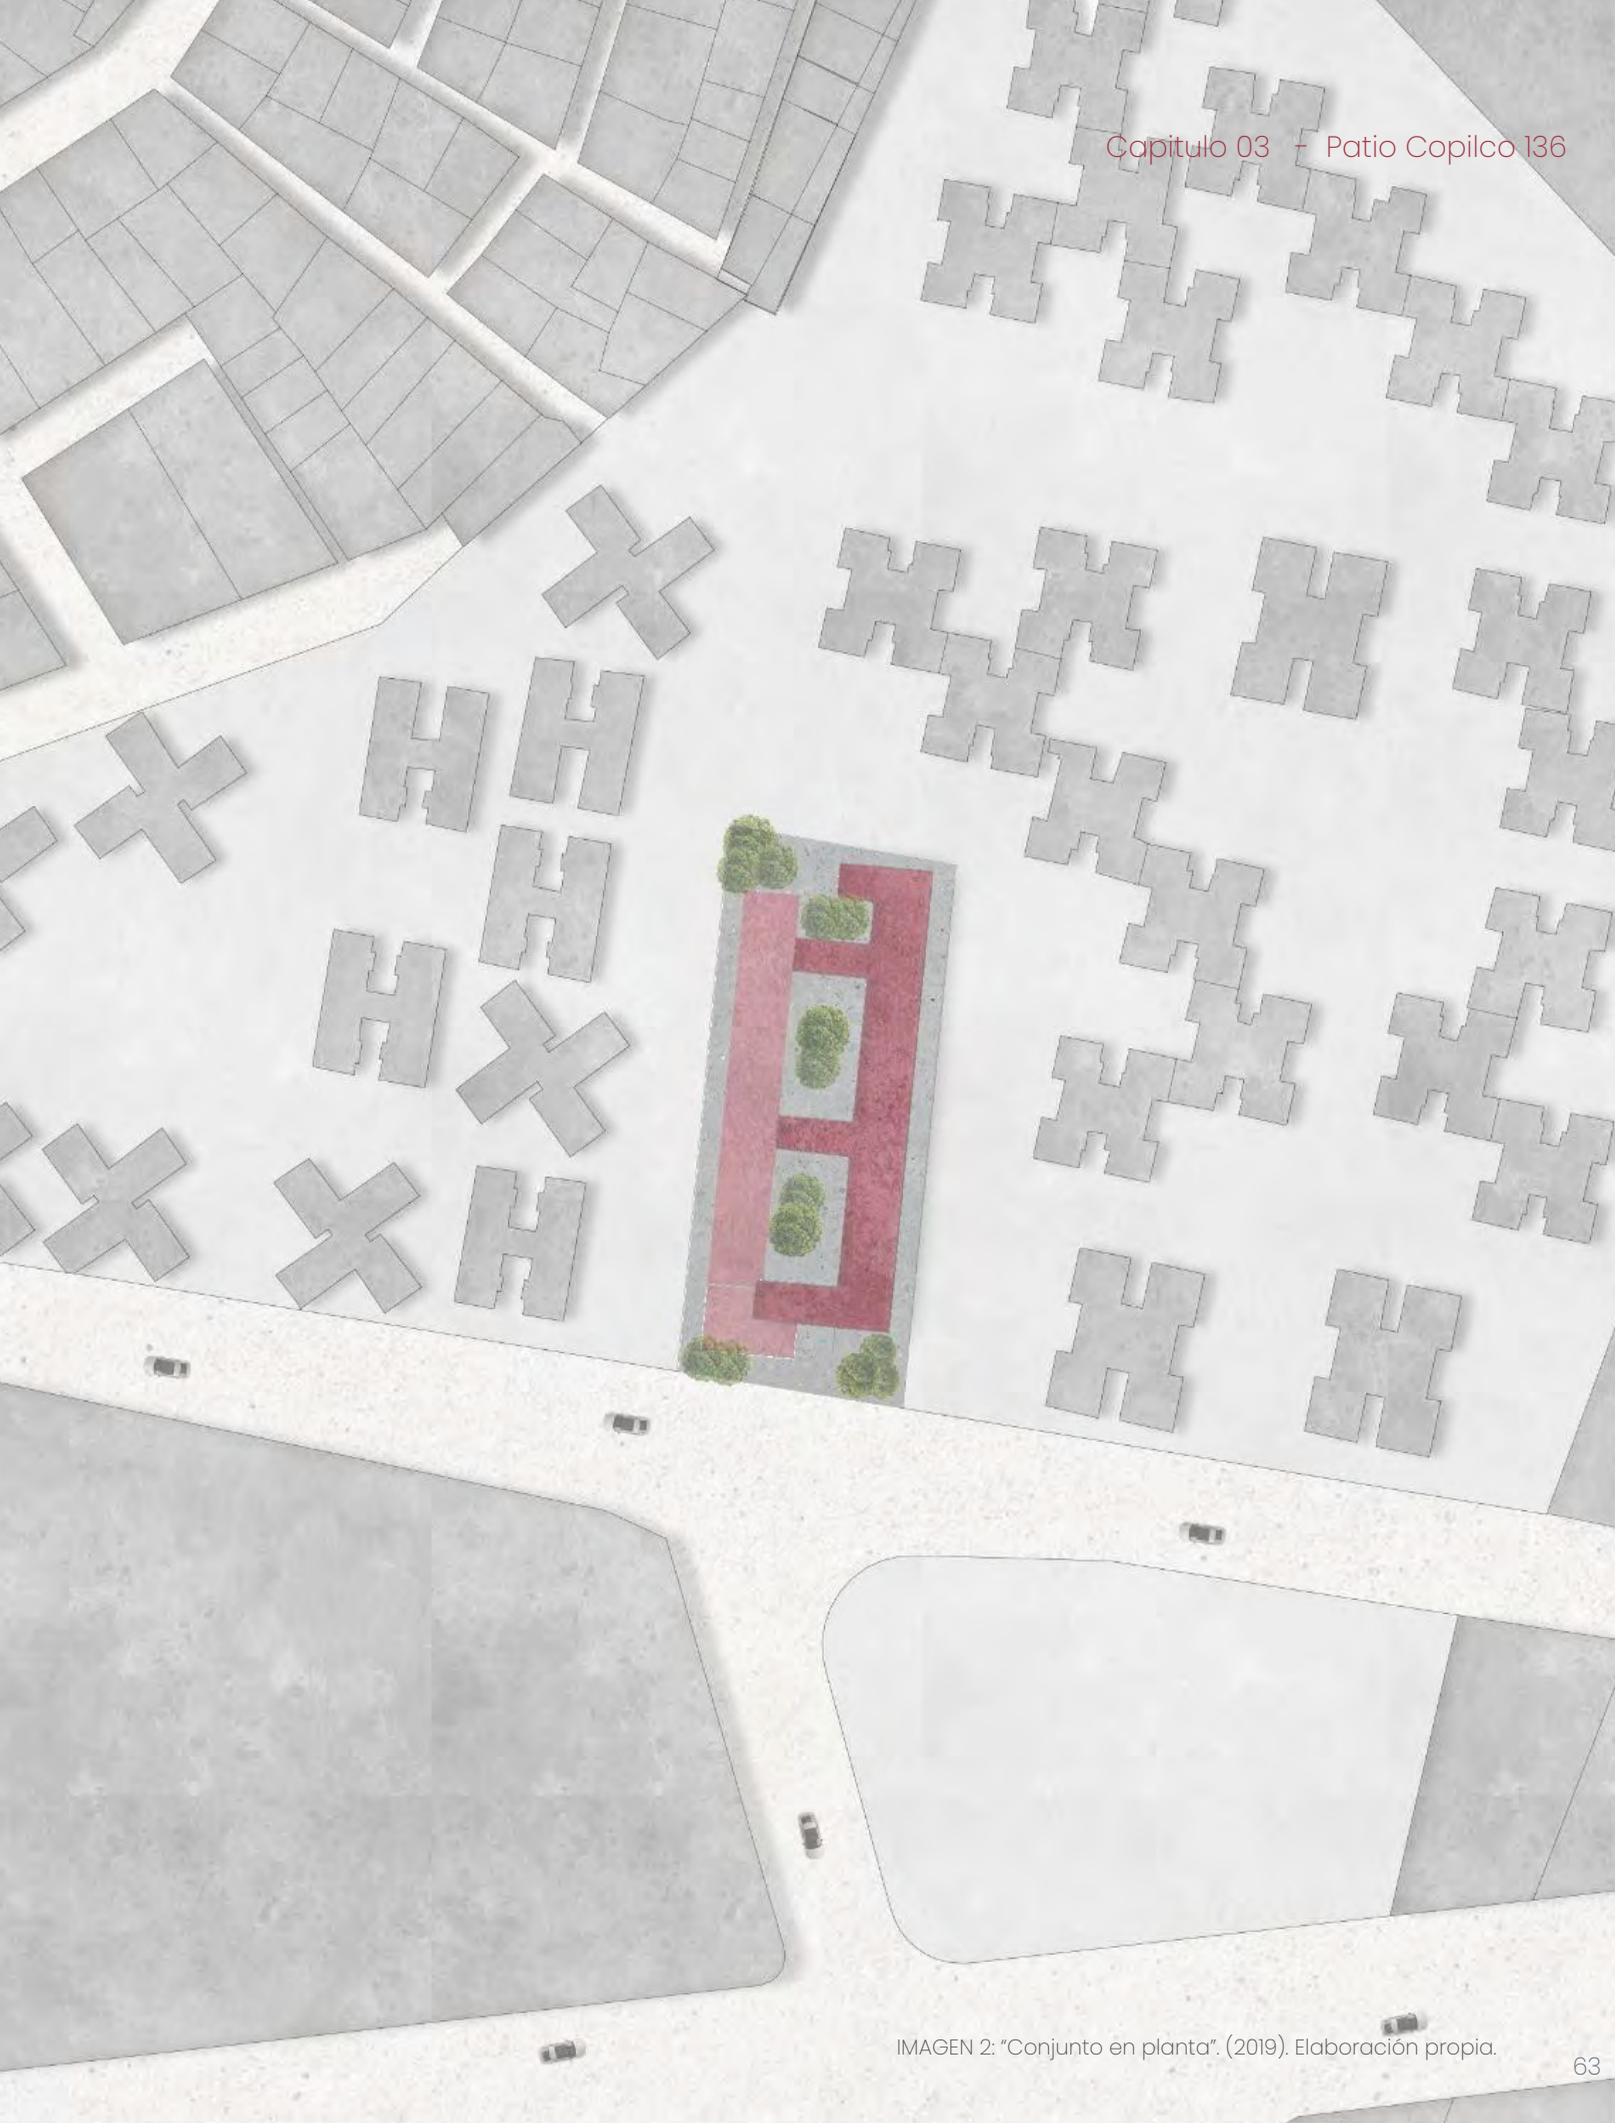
"Conjunto en planta". (2019). Elaboración propia.
